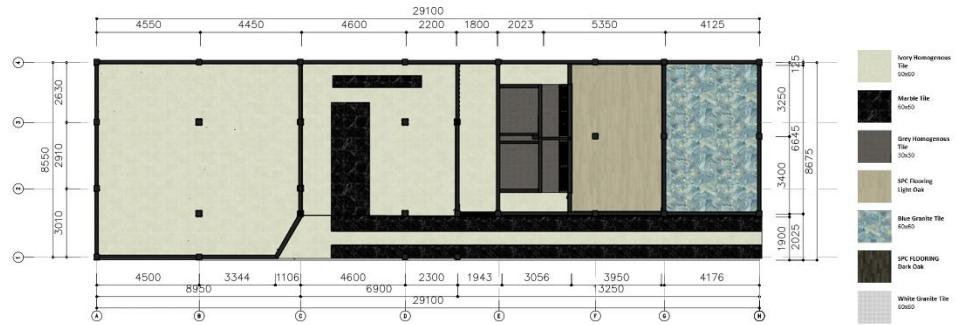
Alternatif 1 Rencana Lantai 2
